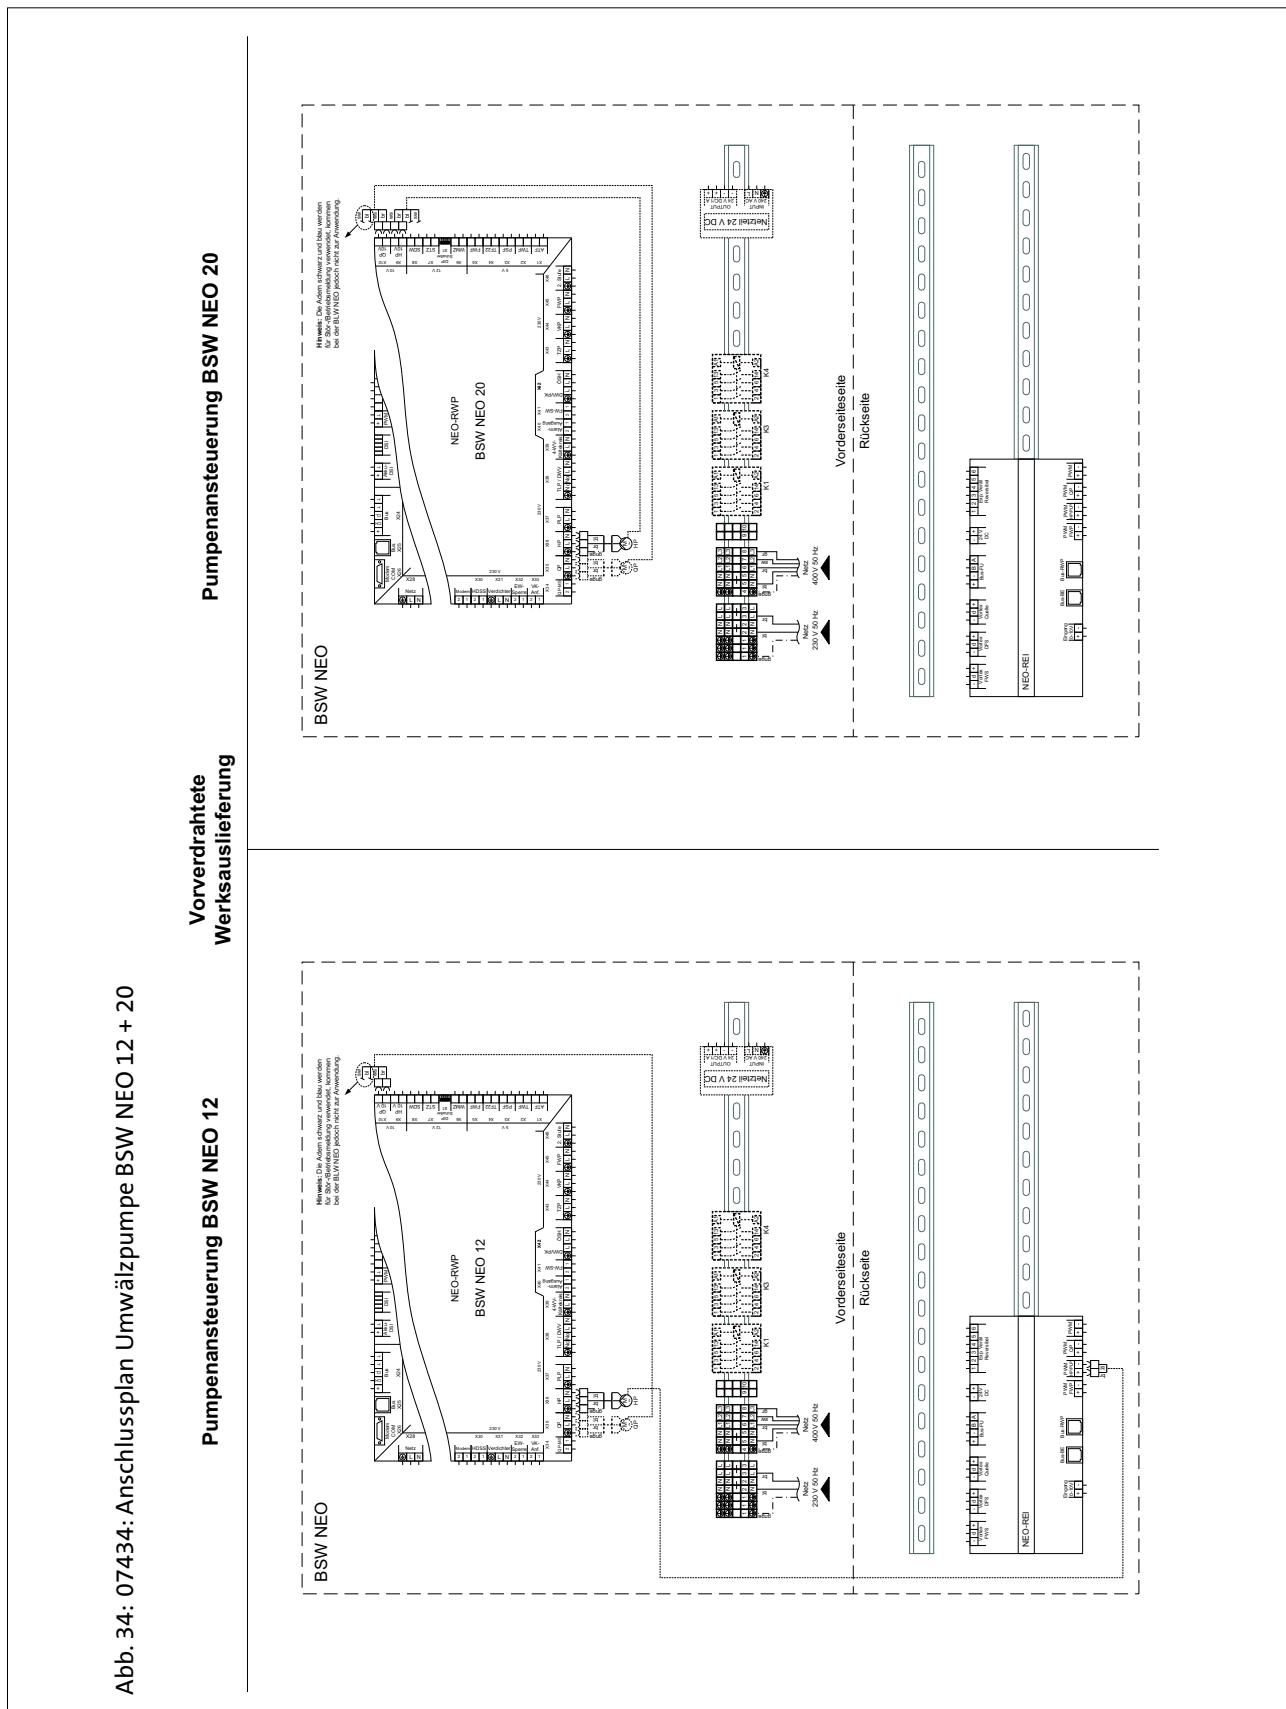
07434: Anschlussplan Umwälzpumpe BSW NEO 12 + 20
